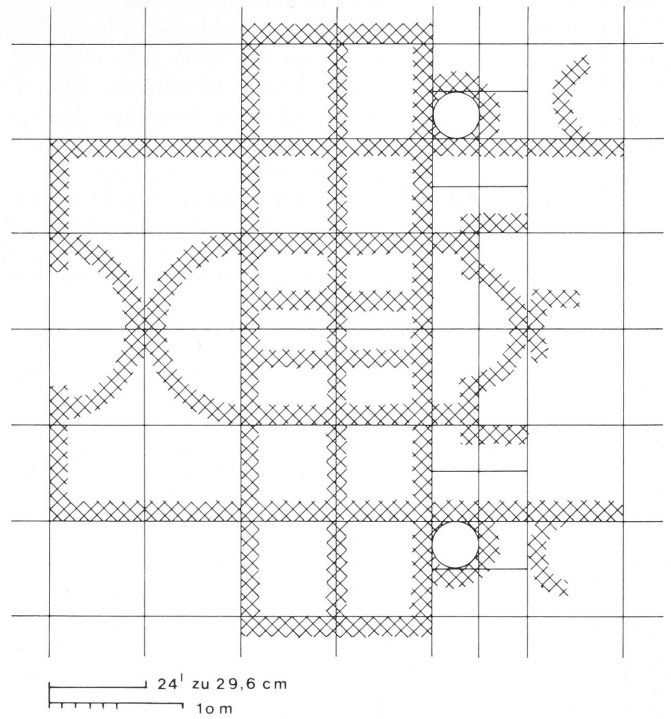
Rekonstruktionsversuche Erdgeschoßgrundriß. C. Meckseper.
